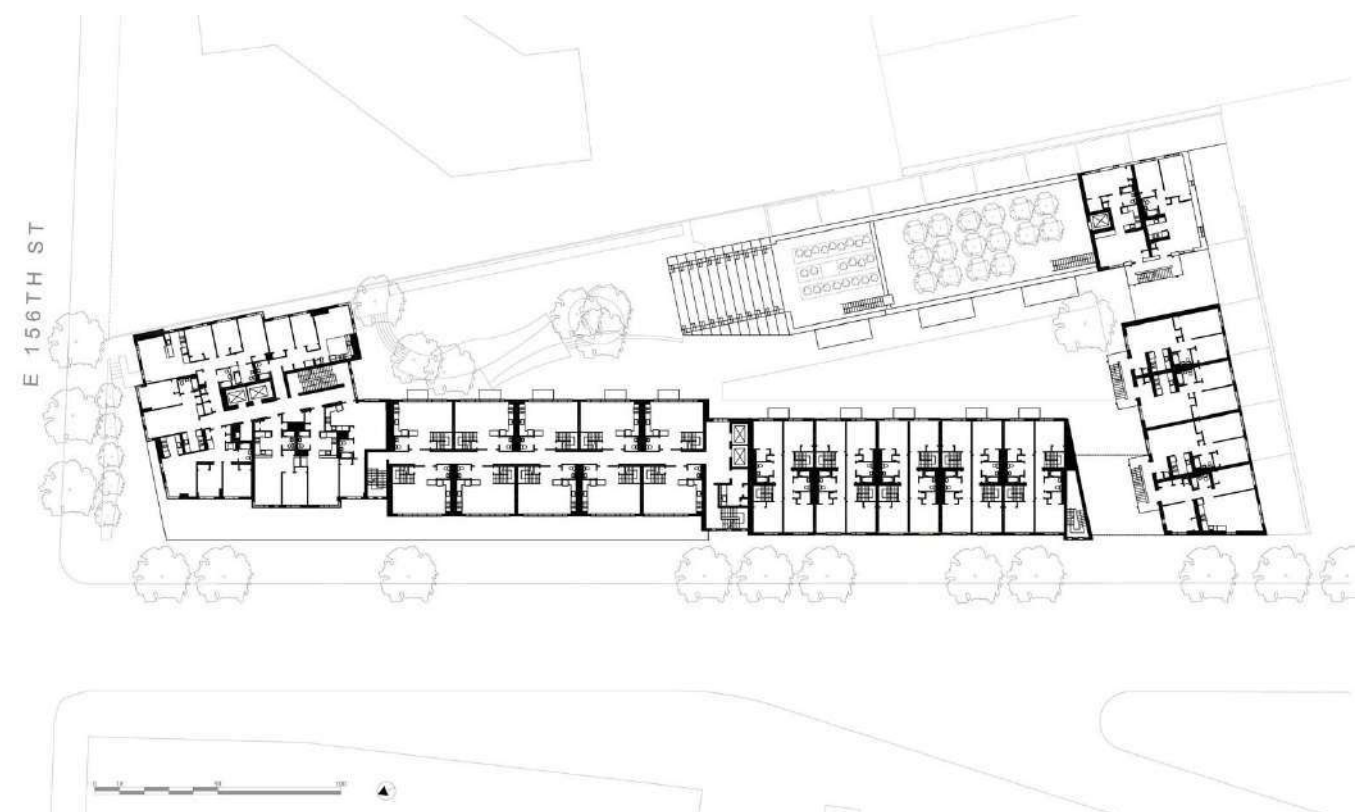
planta do térreo. Fonte: <https://www.archdaily.com.br/01-181999/via-verde>.
